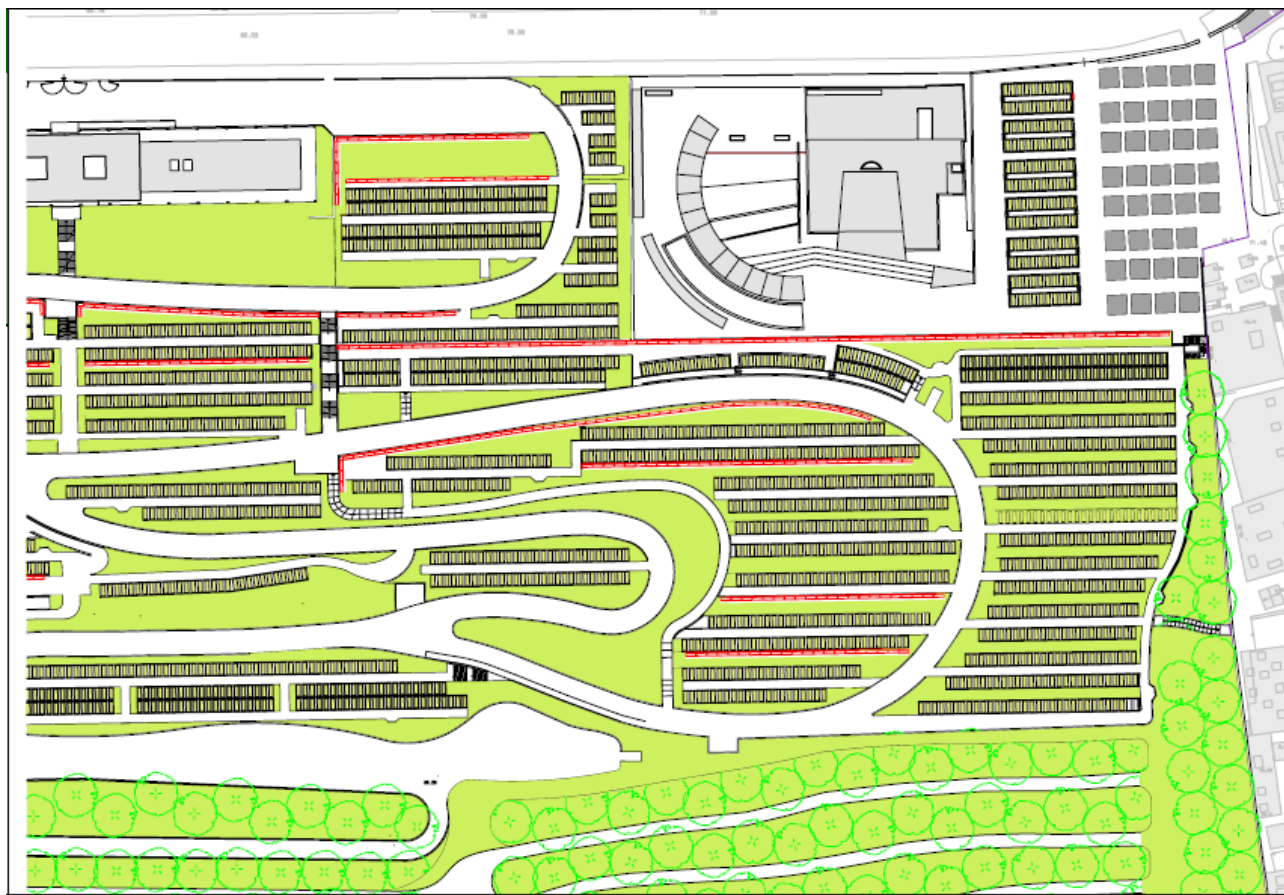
Progetto Preliminare - Pianta Area del Fondo Zevola - Elaborato PR_AR_004.06
